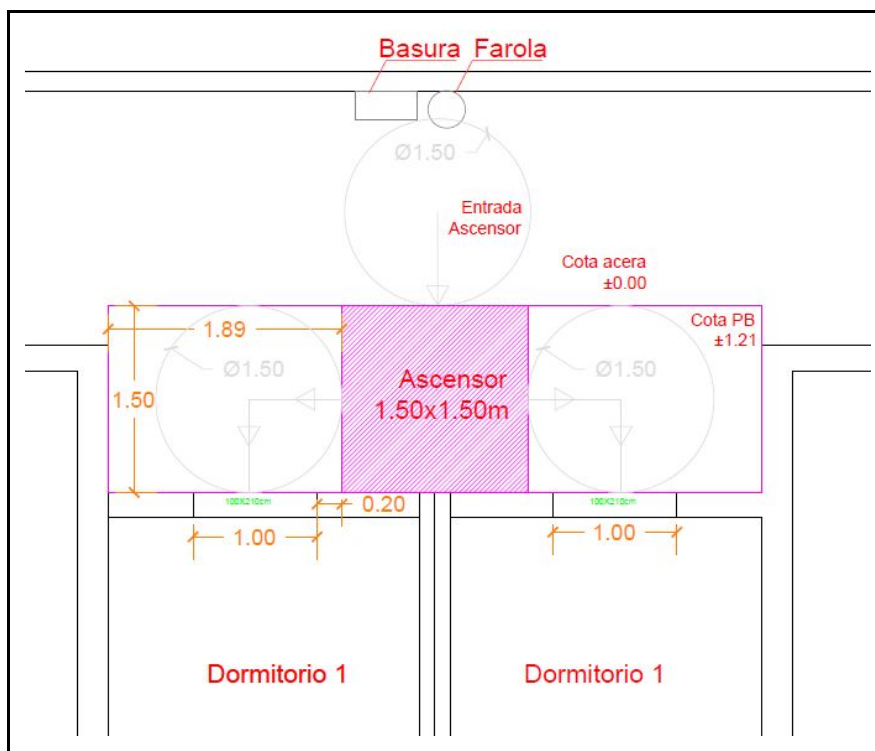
Justificación plataforma en planta baja (Fuente: Anejo A)
